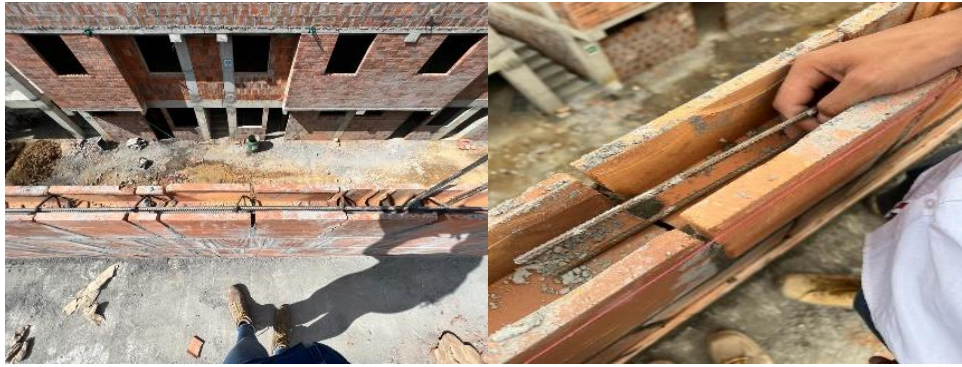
, Refuerzo de antepechos , Fuente : Autoría propia.
